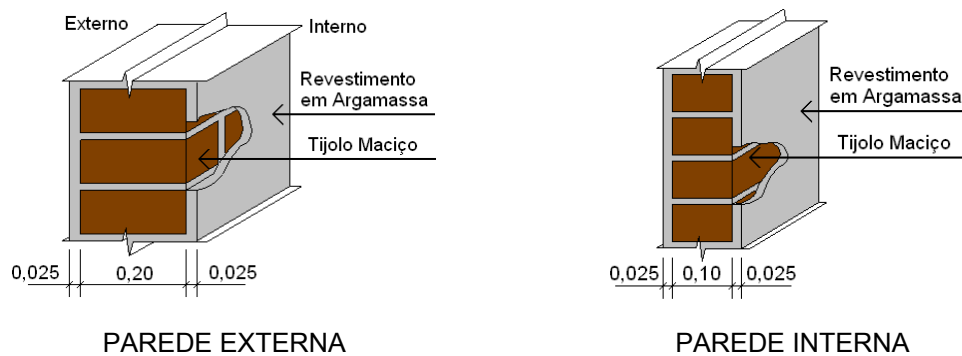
Detalhe construtivo das alvenarias externa e interna - Ambiente 2.
